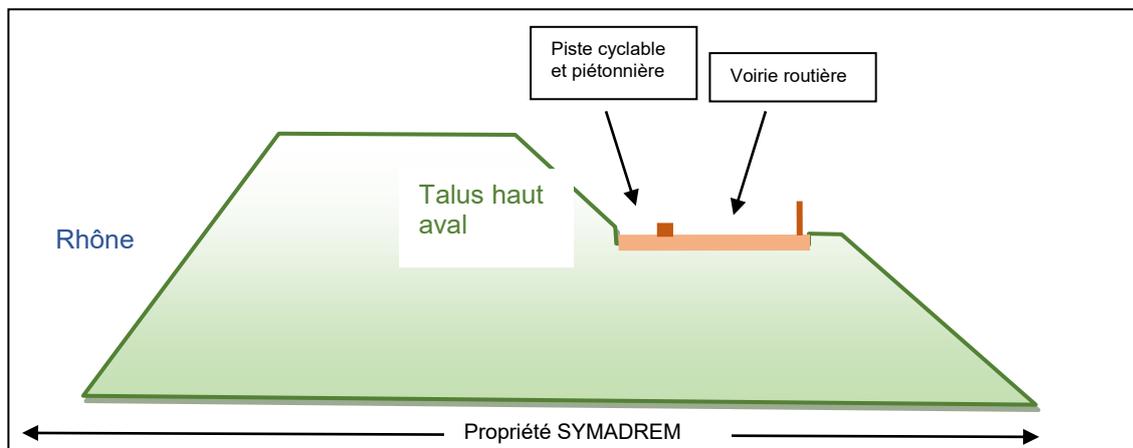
Schéma du profil en travers de la rampe supportant la piste et la voirie
